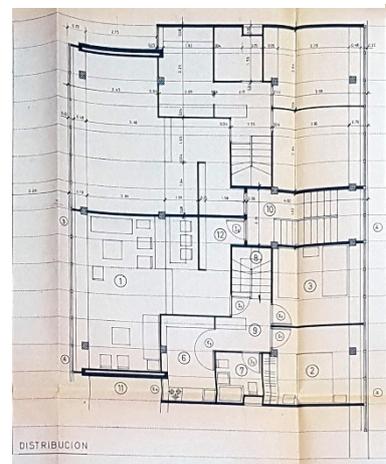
Planta primera dúplex Distribución B-2-4. 1964. Fuente: Archivo Municipal da Coruña
